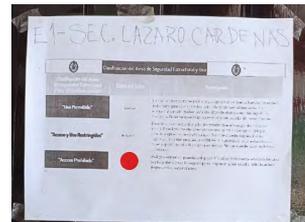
Dictámenes de uso, colocados en las fachadas o puertas principales de las estructuras
